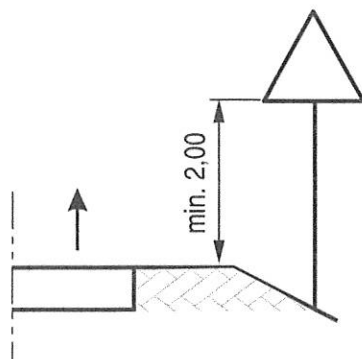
Odległość znaku od krawędzi jezdni na drodze
